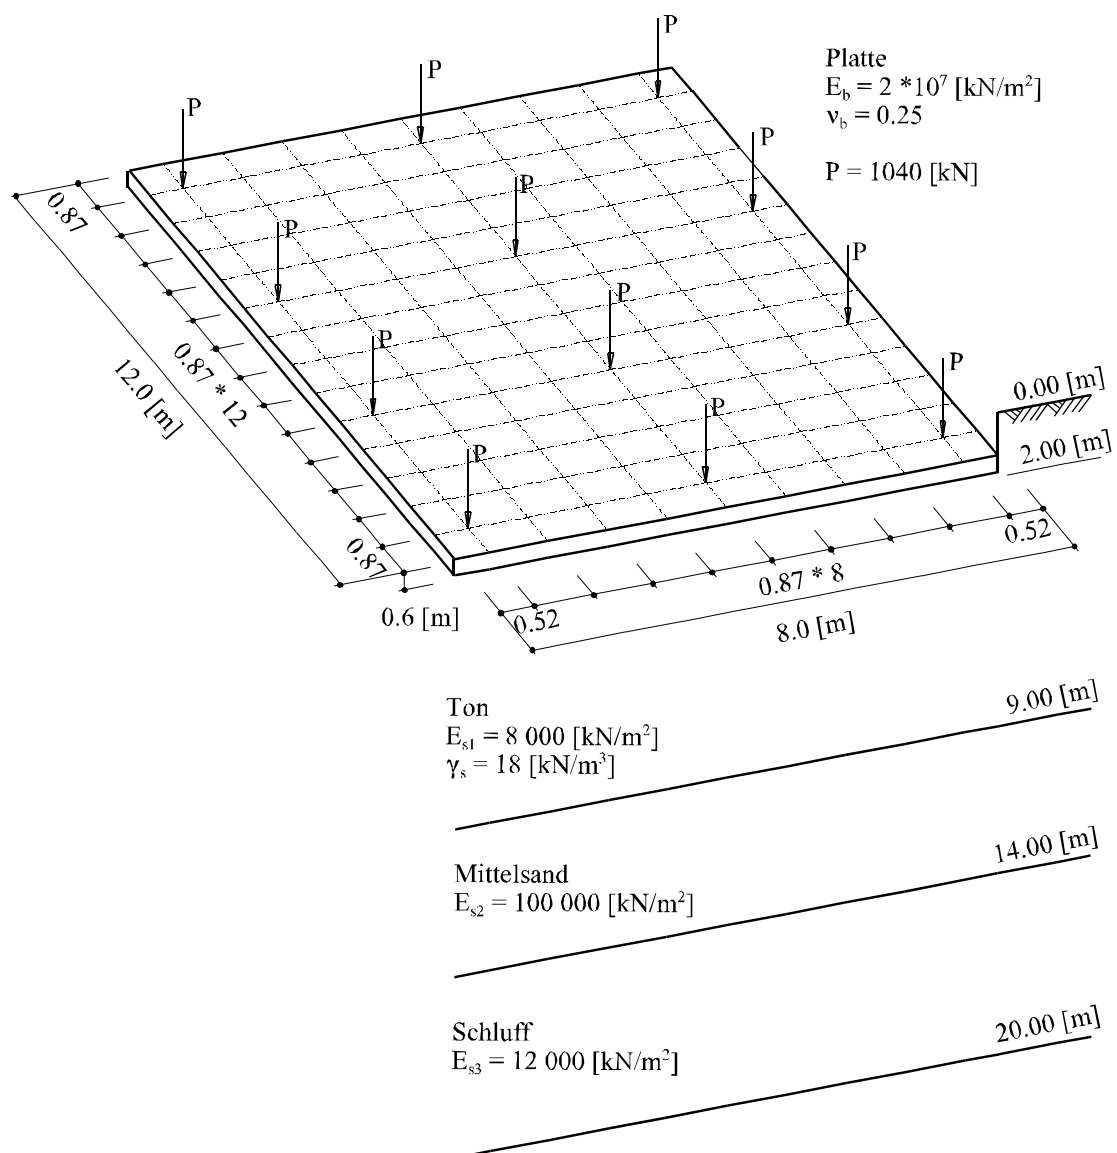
Grundriss der Platte, Belastung, FE-Netz und Schichtung des Baugrunds
